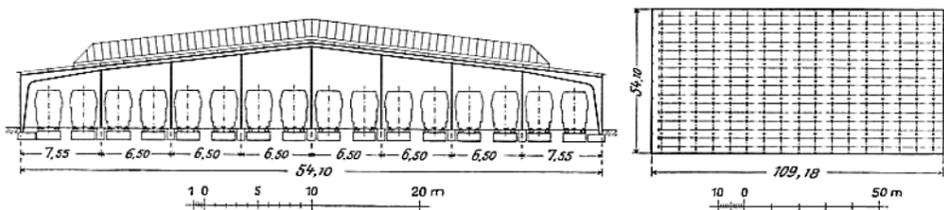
Abstellhalle auf Betriebsbahnhof Grunewald.
